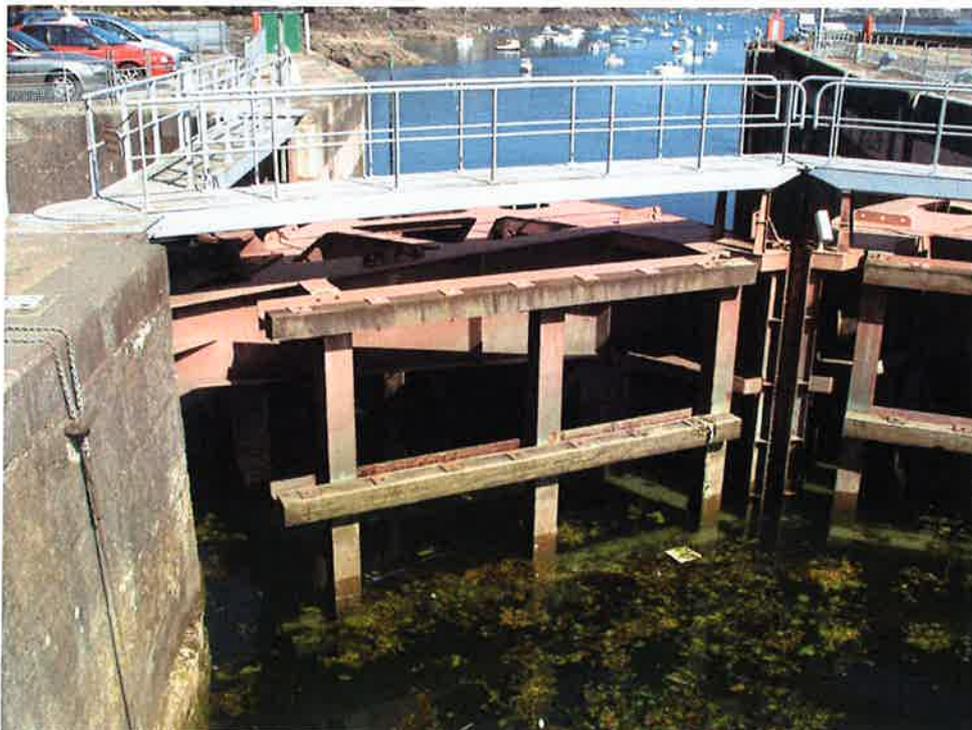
CONCA DELLA RANCE – ST. MALO – PASSERELLE DI COLLEGAMENTO LATO MARE
